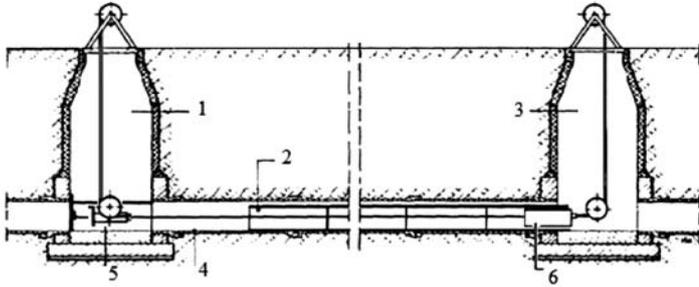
Монтаж нового трубопровода без растягивающих усилий:
